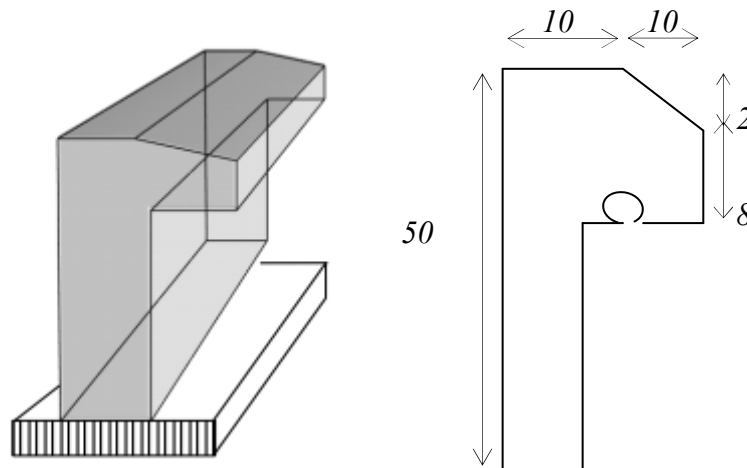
Dimensions d'acrotère Pour terrasse inaccessible
